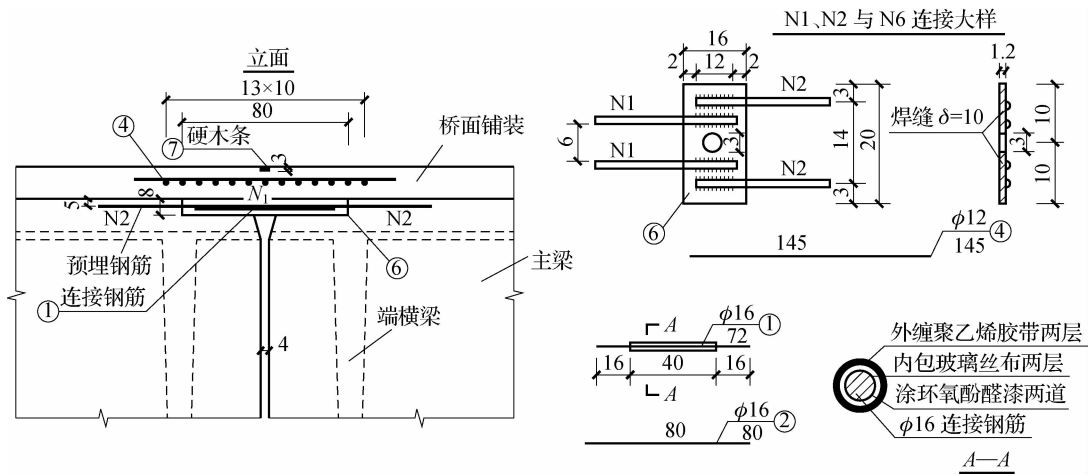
简支梁桥四跨一联时的桥面连续构造(尺寸单位:cm,钢筋直径:mm)
